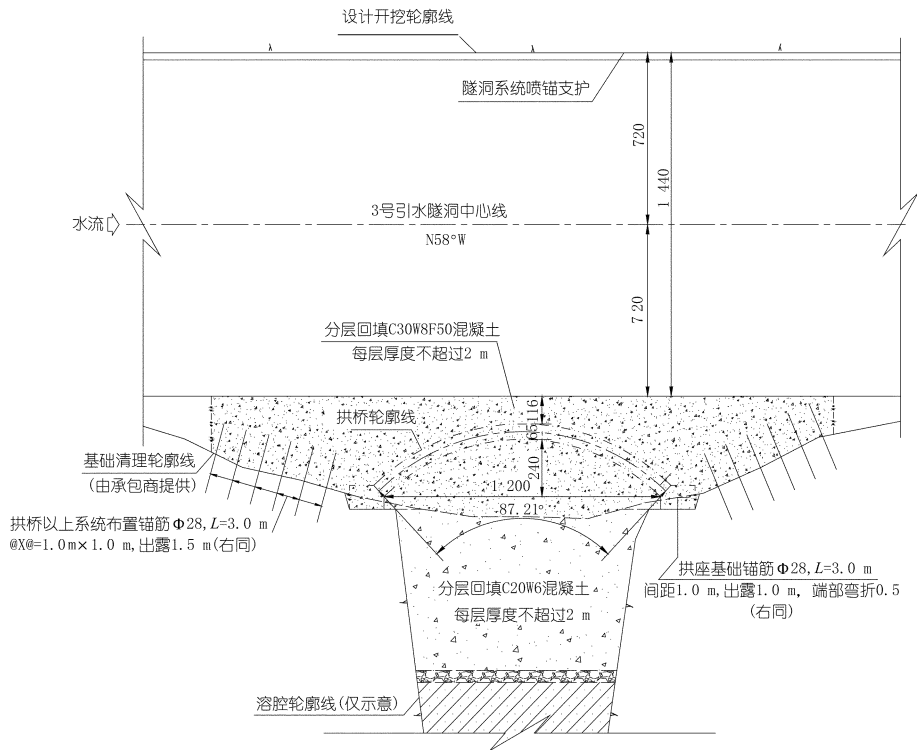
底板溶腔处理施工措施示意(尺寸单位:cm)
